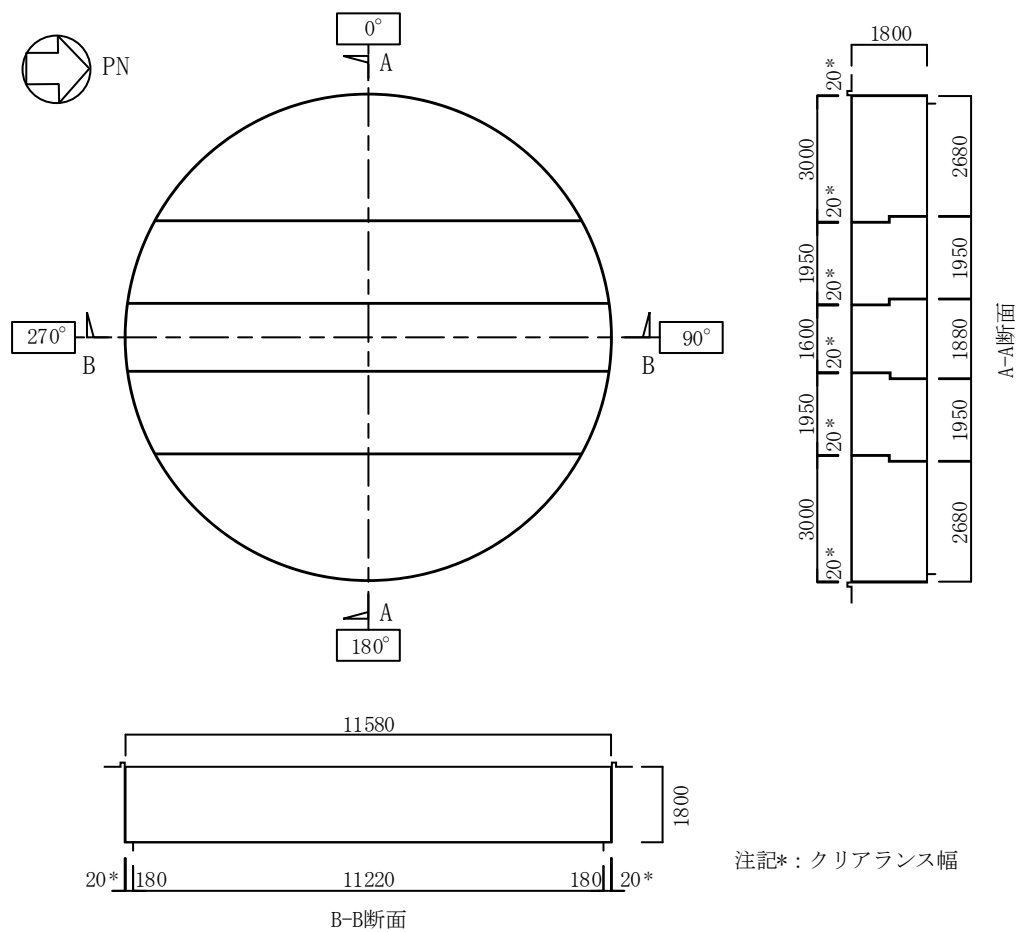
原子炉ウェルシールドプラグ概要図 (単位: mm)
